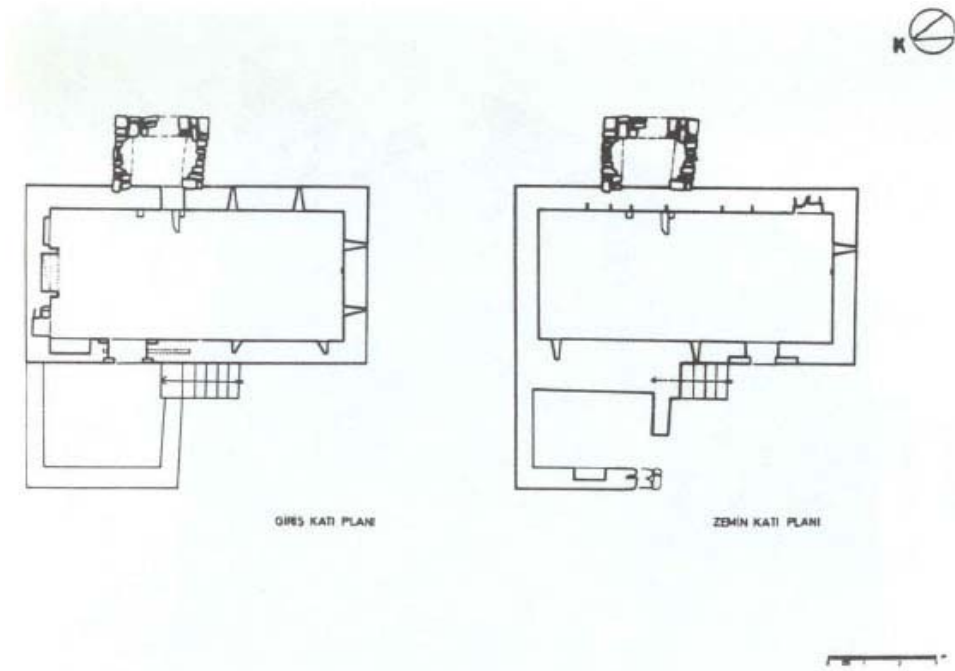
Bodrum, Şerif Mehmet Çıkmazı “Beyza Yıldızhan evi” Kule ev Vaziyet Planı (Arel, 1988)
